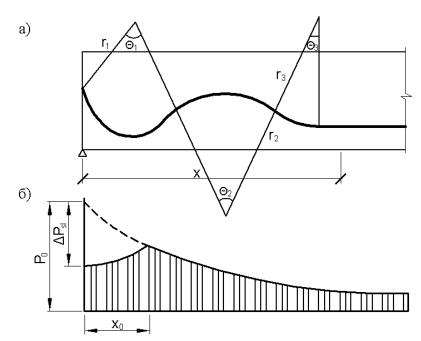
Обозначения, принятые при расчете потерь, вызванных: а - трением; б - проскальзыванием арматуры в анкерных устройствах
